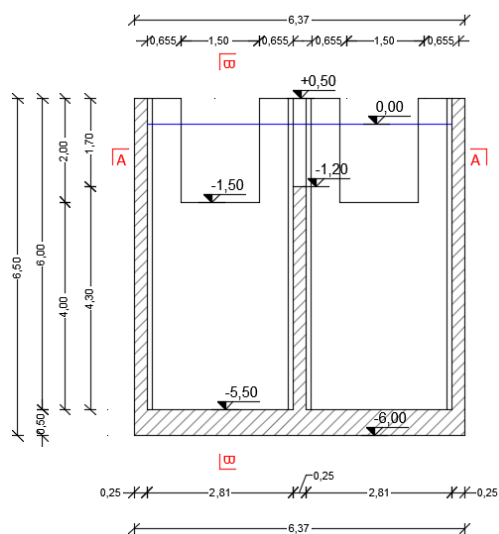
Cassone tipo G4: carpenteria – Sezione verticale C-C
